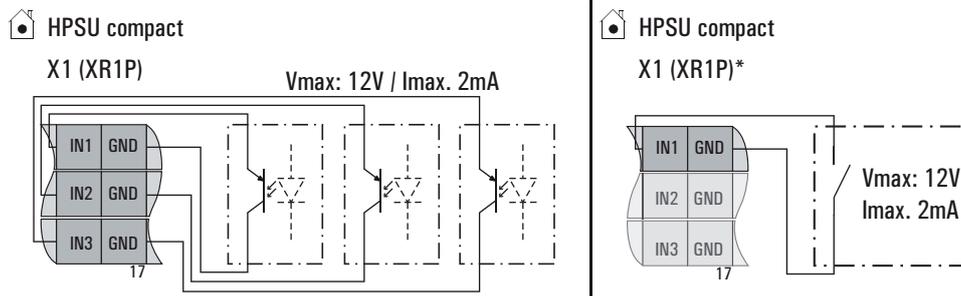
Collegamento ingresso impulsi del contatore di corrente (\* collegamento alternativo)
